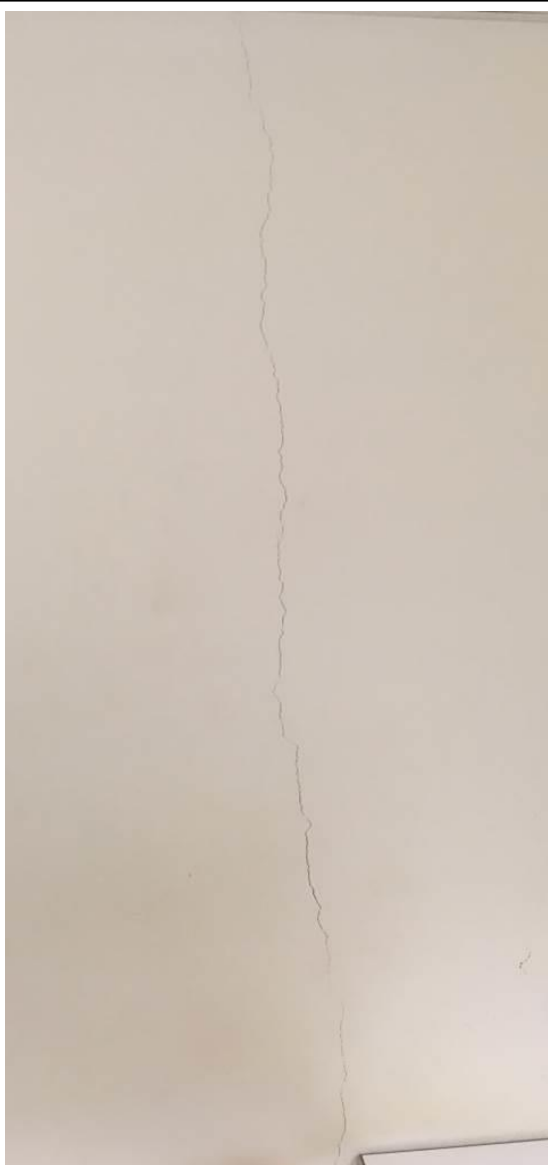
Bâtiment B RDC, local technique - Paroi verticale : D2 – Fissuration modérée.
